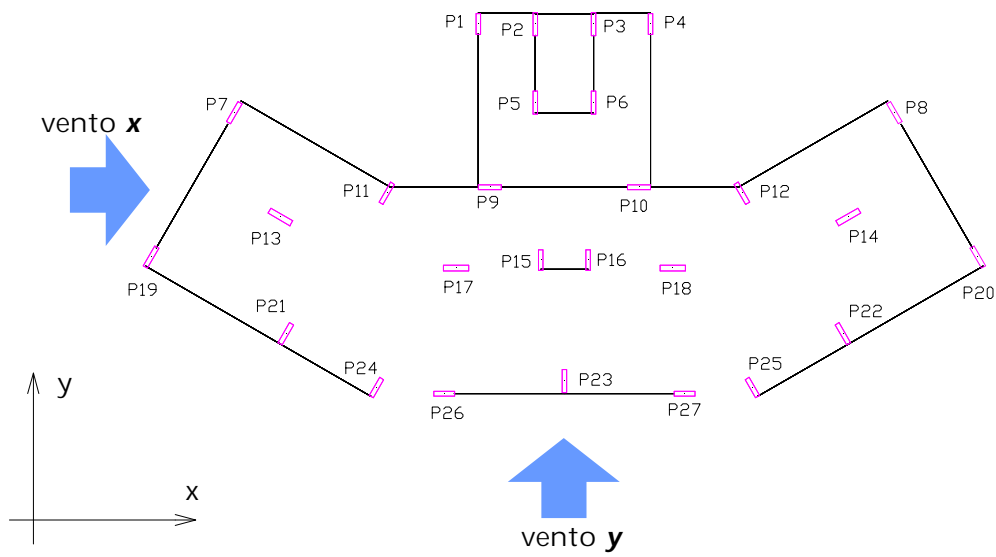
Esquema de aplicação das ações horizontais ao pórtico do ed. Manhattan.
